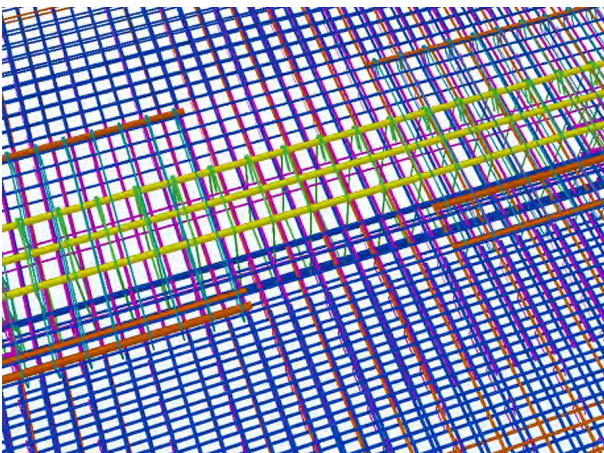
Detalle de Tekla de encuentro losa apoyada en el terreno / viga de cimentación
